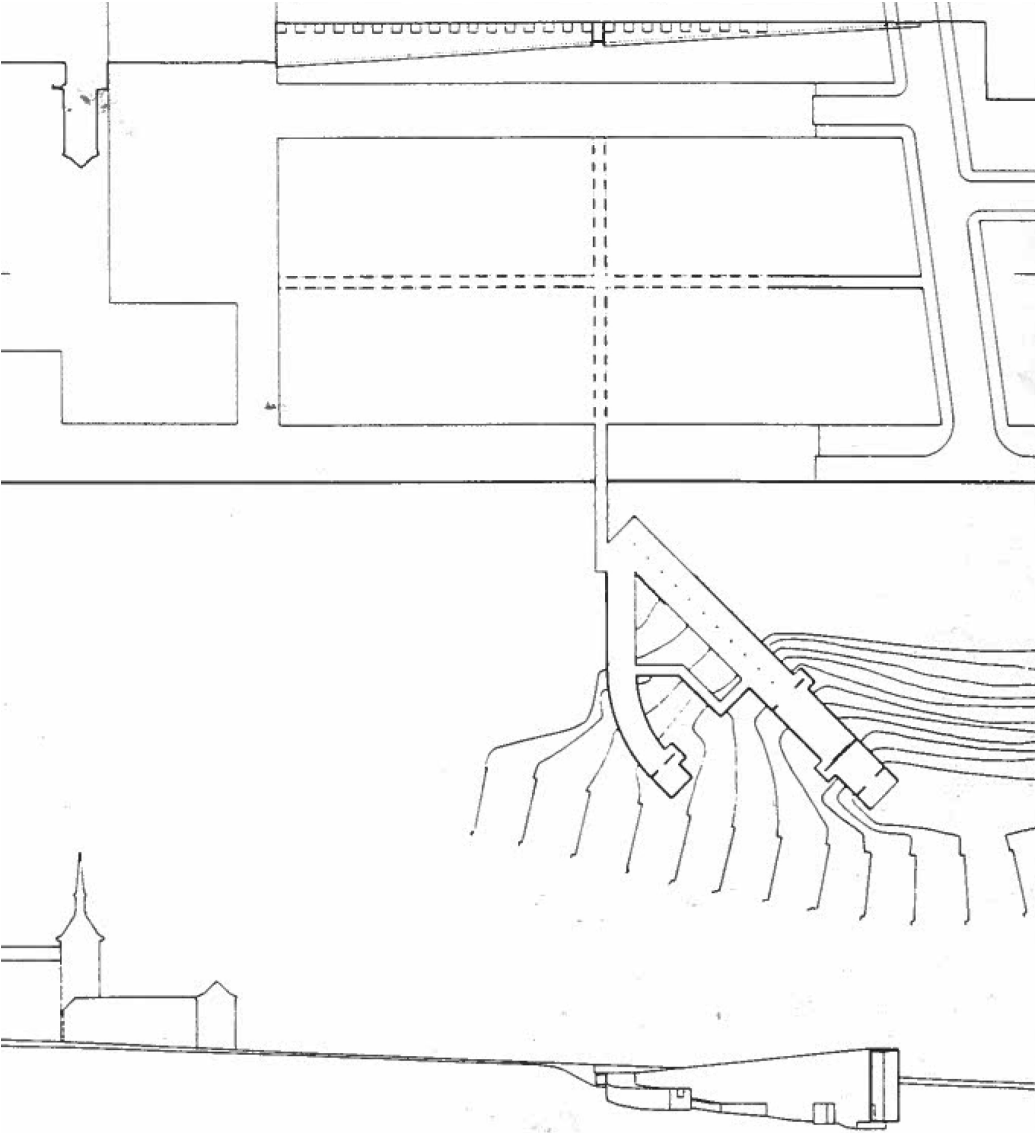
Álvaro Siza, Museu para dois *Picasso*, planta e alçados do museu
